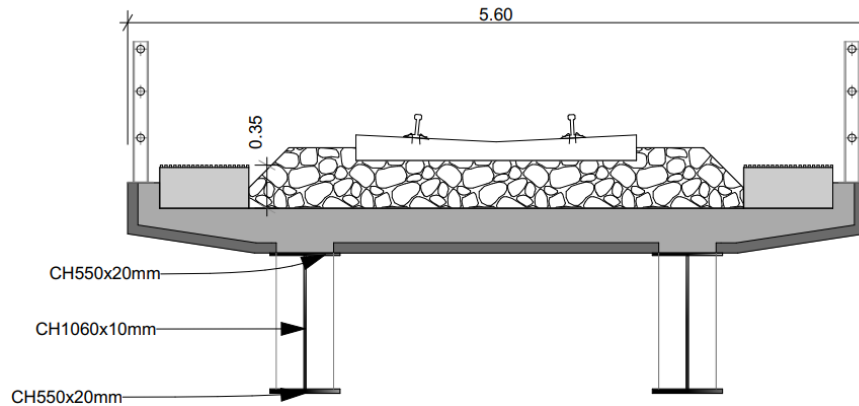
Perfil transversal após as alterações (Fonte: Autor)
